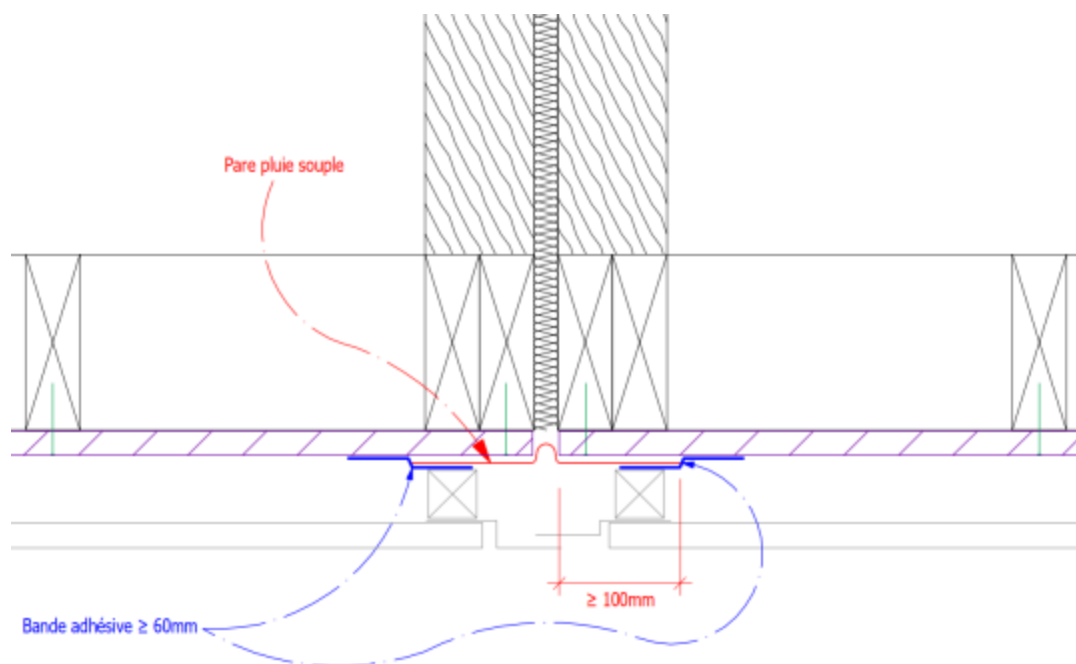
Exemple de dispositions minimales de ventilation au droit d'un recouvrement horizontal de la lame d'air (FOB ; hors dispositions de sécurité incendie)
